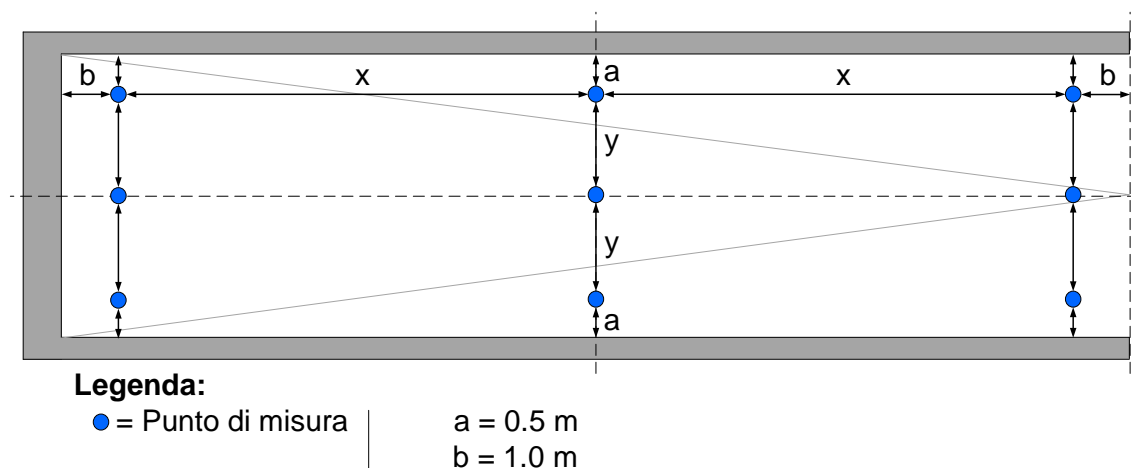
Disposizione dei punti di misura nel caso di rampe con illuminazione dall'alto.
